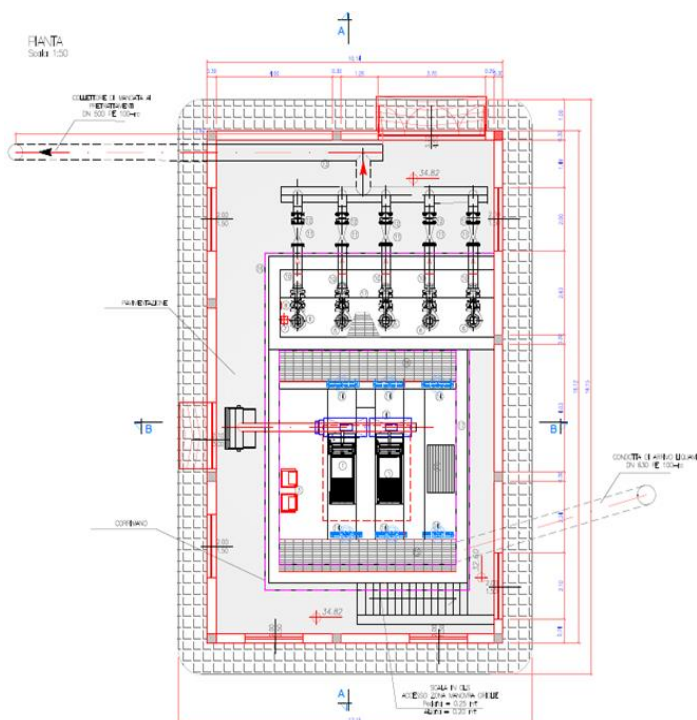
Pianta -Nuovo edificio grig. grossolana
